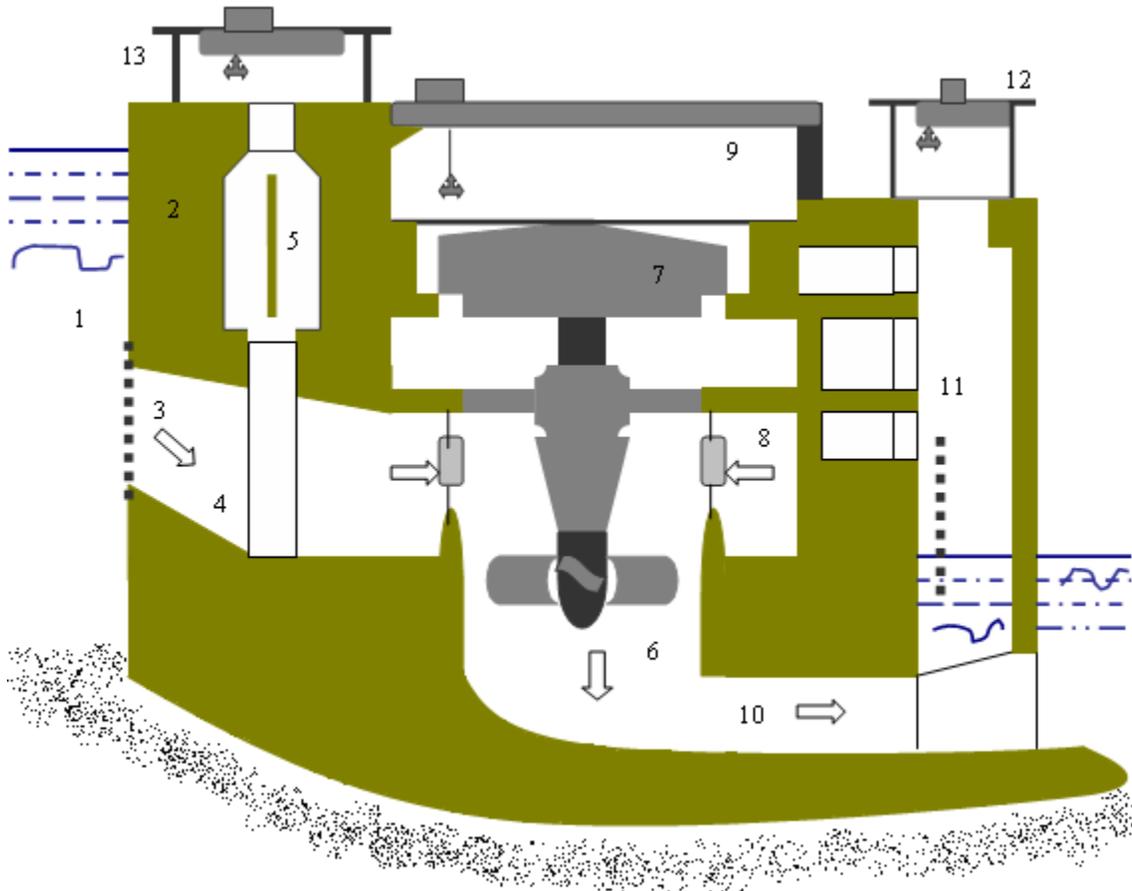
Corte esquemático de una planta hidroeléctrica de caudal elevado y baja caída⁽¹⁰⁾
